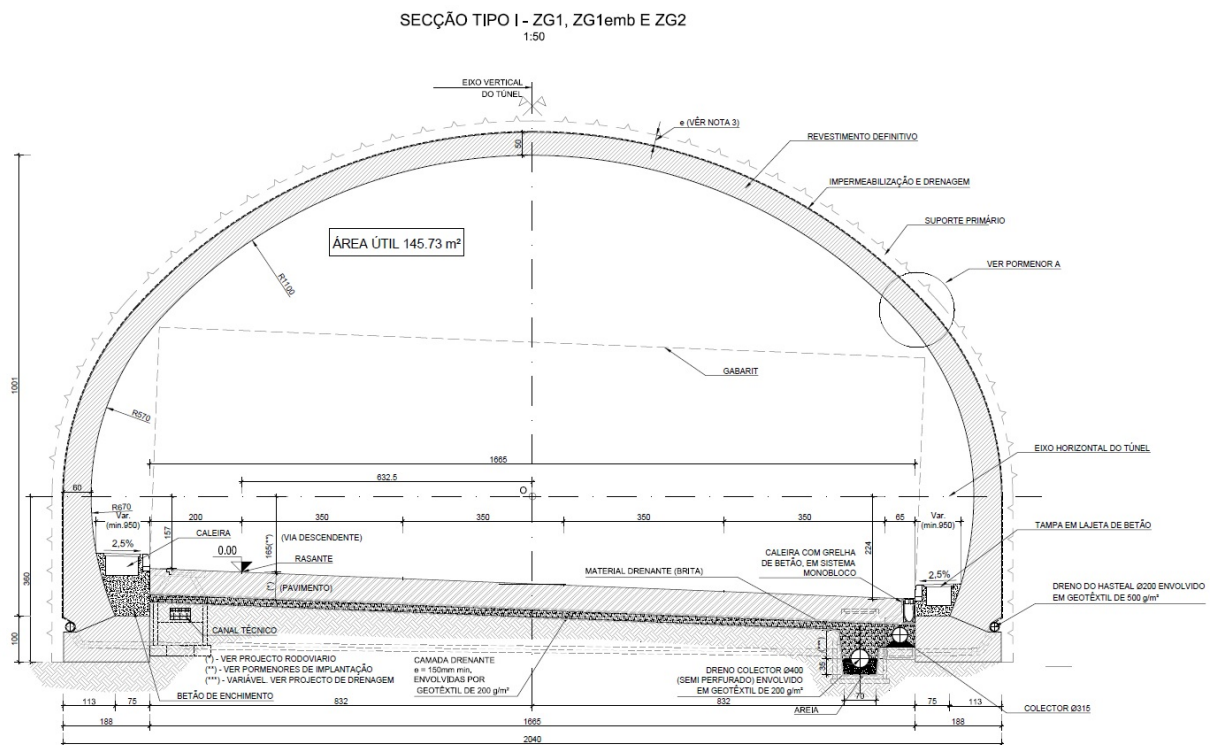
Secção Tipo I para zonamento ZG1 e ZG2
